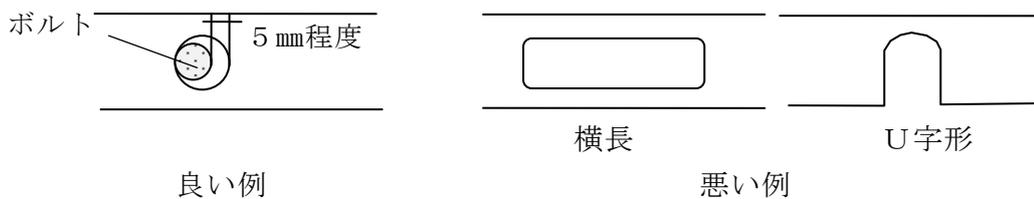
アンカーボルト用の孔の形状 (平面図)
